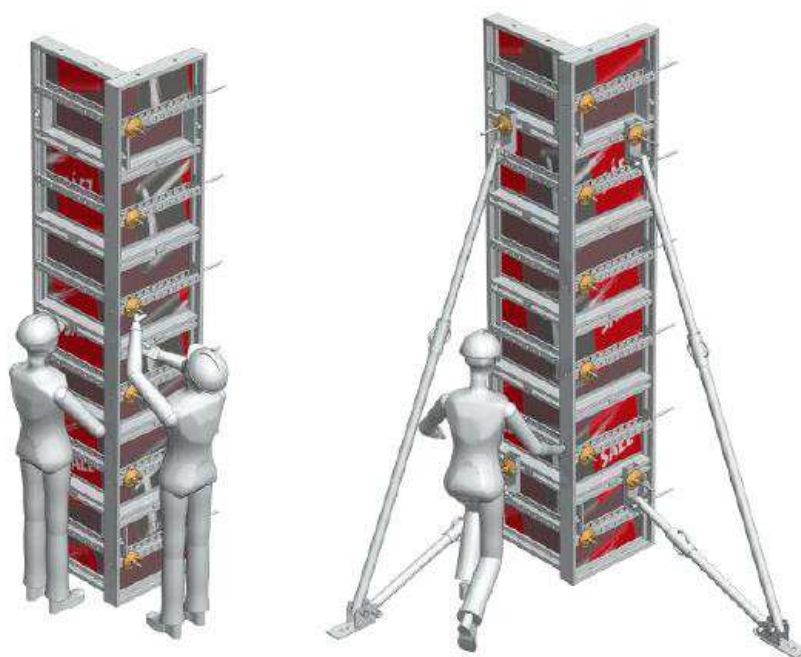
Укрупнительная сборка и закрепление щитов опалубки
